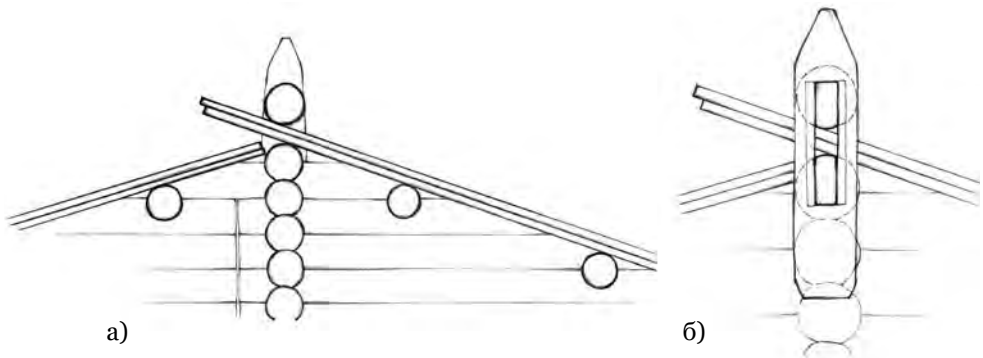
Конструкция безгвоздевой самцово-слеговой кровли с гнетами и «чиби»: а) фрагмент разреза; б) фрагмент фасада
